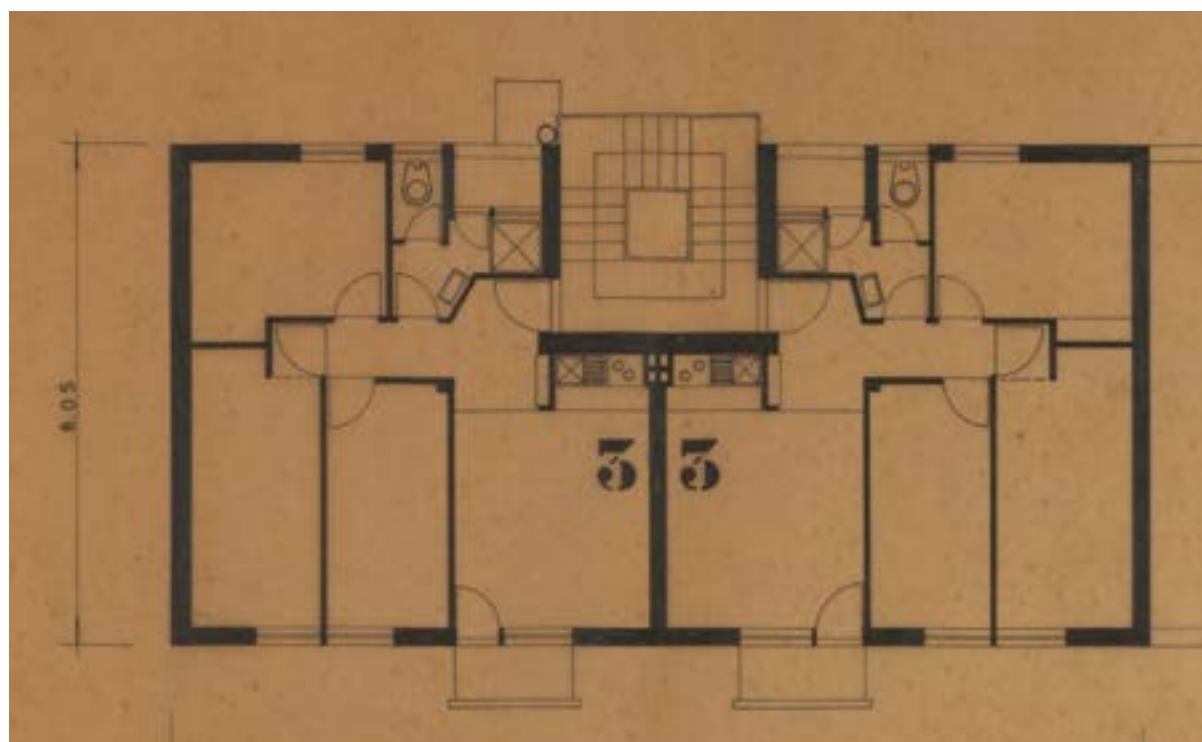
Planta Fogo T1 e T2 - Bairro de Francos
